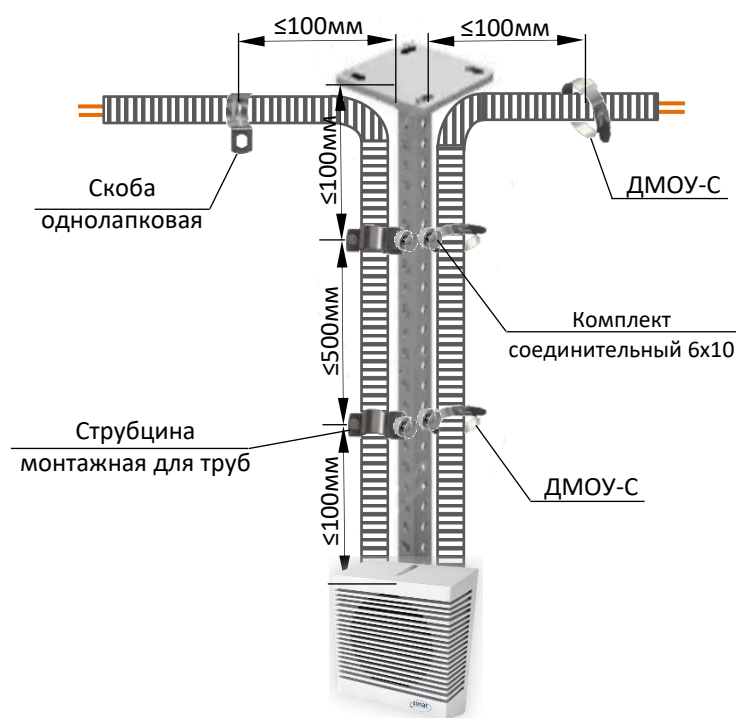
Спуск кабеля по стойке консольной сварной с прокладкой в трубе
